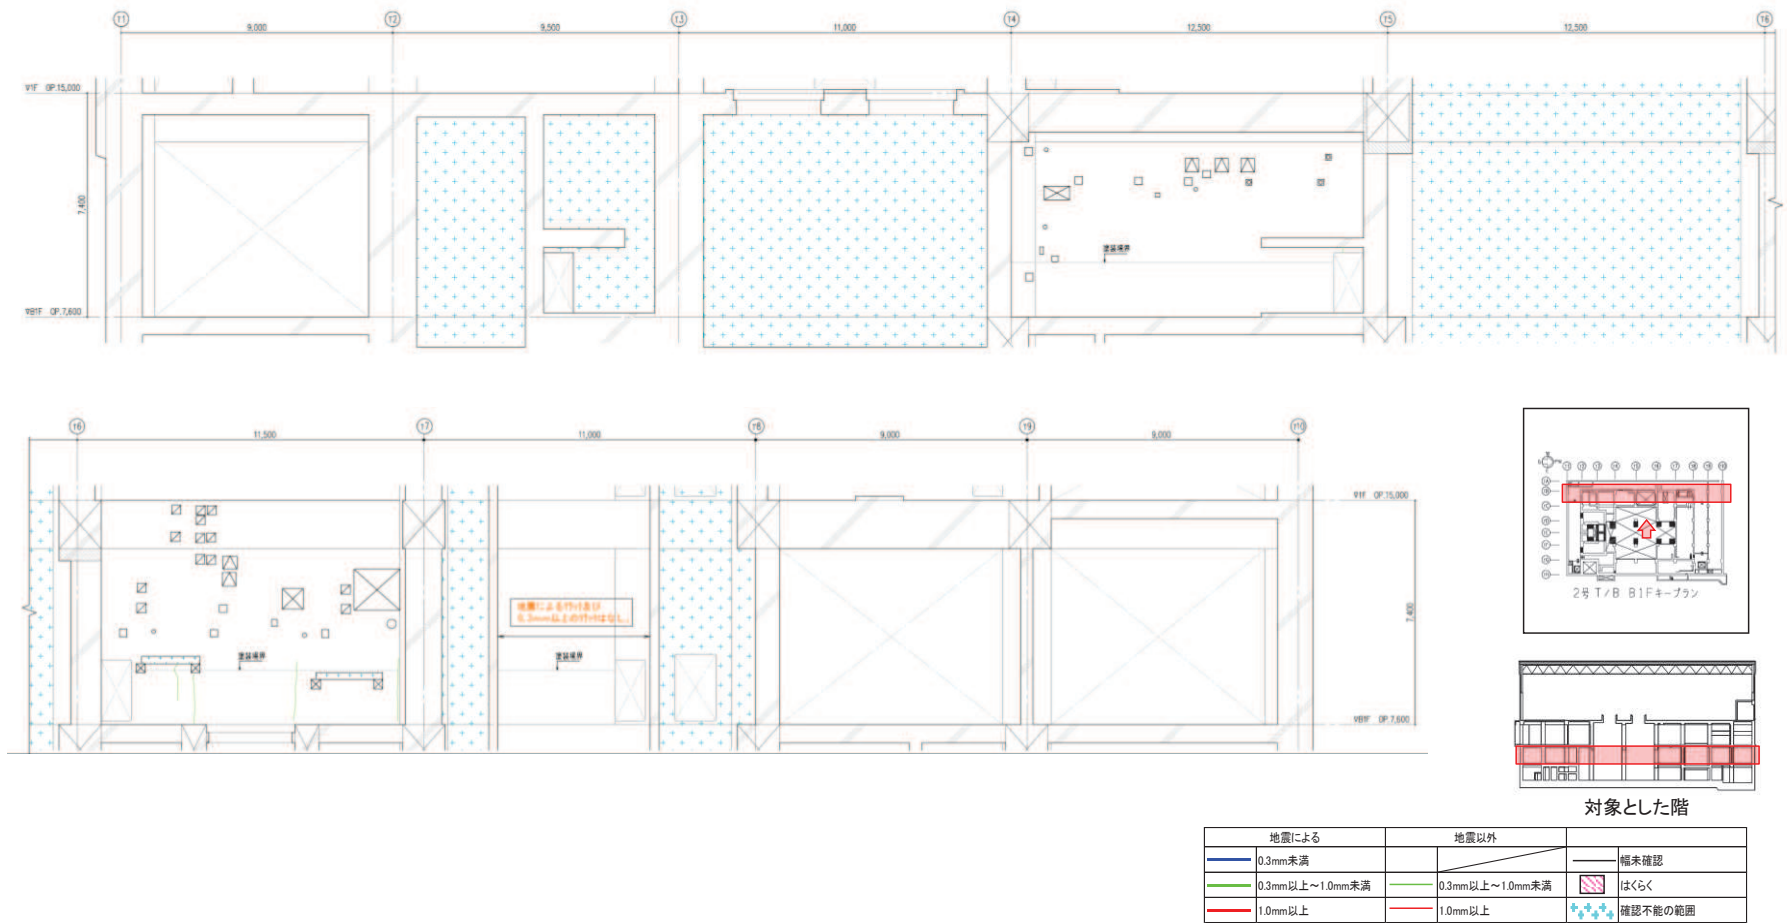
タービン建屋のひび割れ分布 耐震壁 (27) 地下1階 TB 通り
